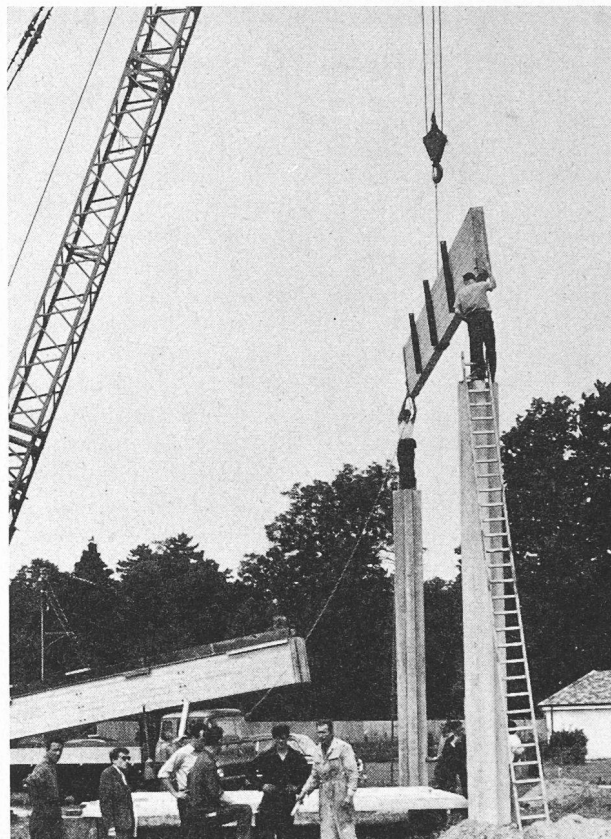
et 16 bis. — Montage du prototype de structure. Poutres en bois collé sur poteaux en béton.
